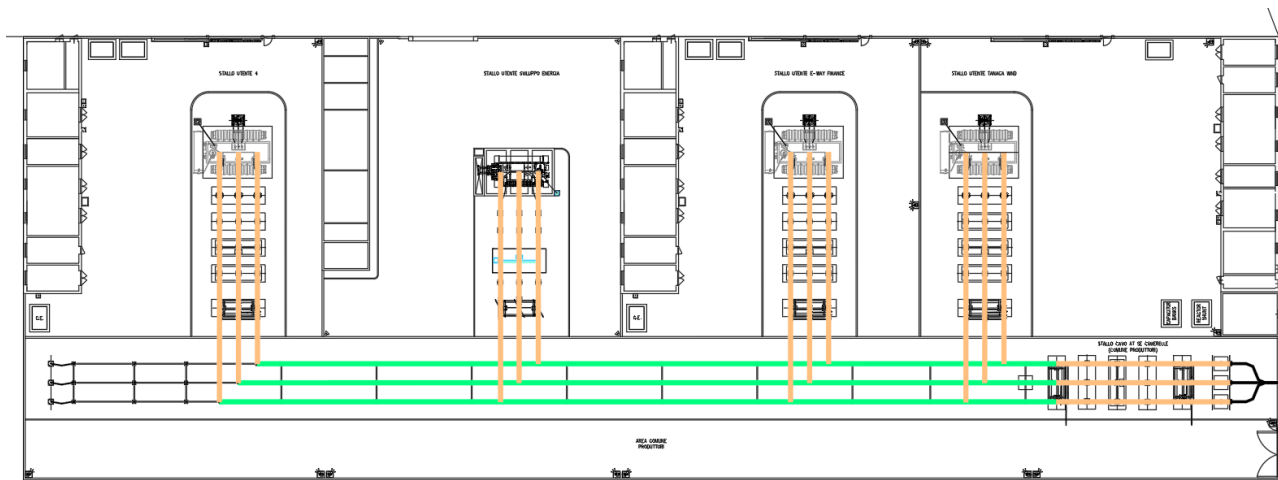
Planimetria del punto di raccolta con individuazione degli elementi attivi
